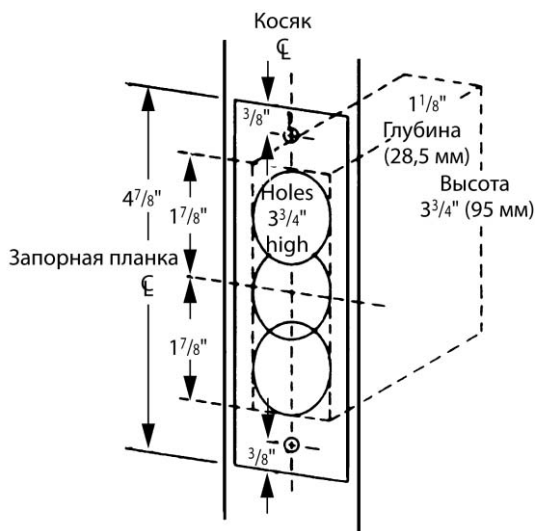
Разметка запорной планки на косяке по шаблону
